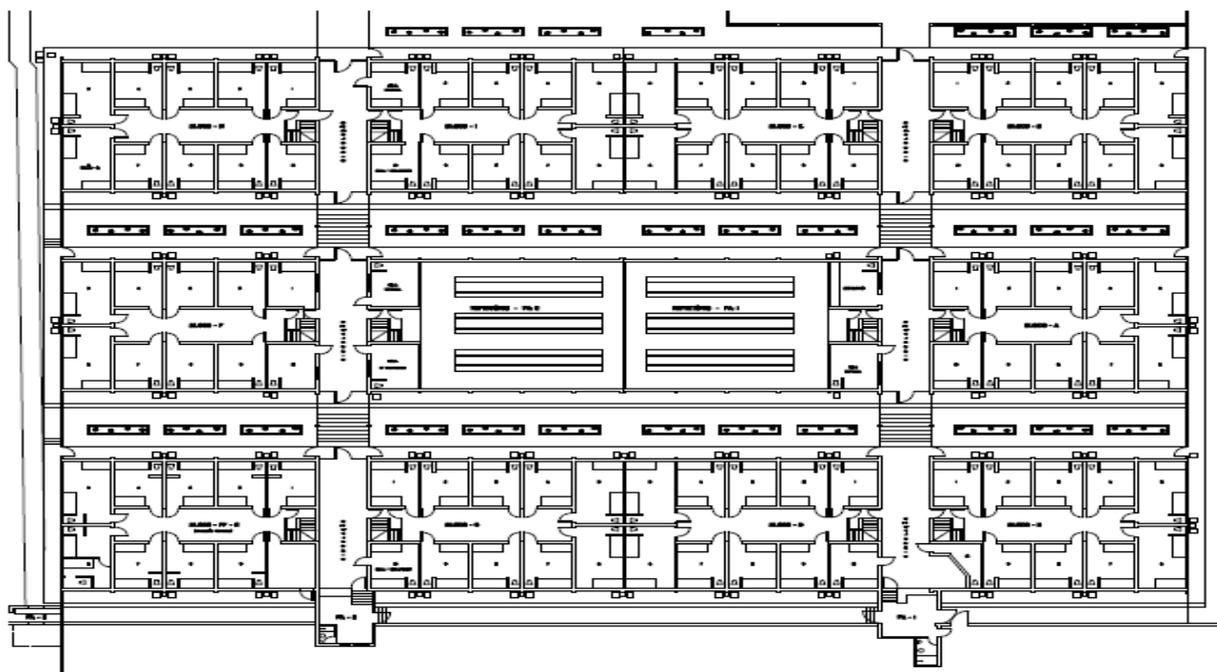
Planta Baixa da Casa de Detenção de Pedrinhas.
